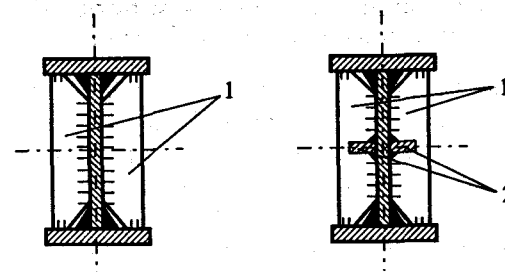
Сплошные сварные балки с ребрами жесткости: 1 — поперечные ребра; 2 — продольные ребра
